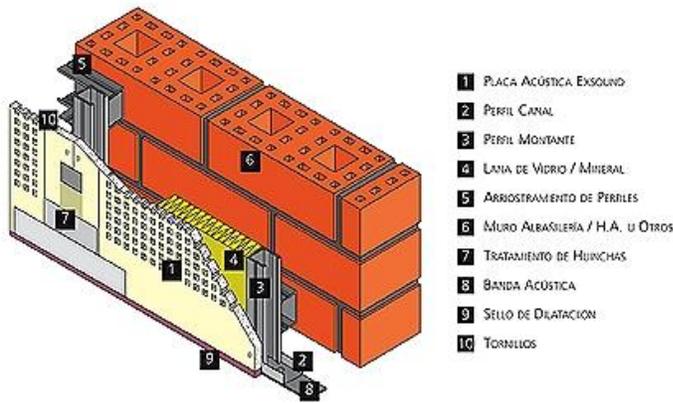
Esquema de sistema constructivo de un muro acústico. Imagen de Etex Group
